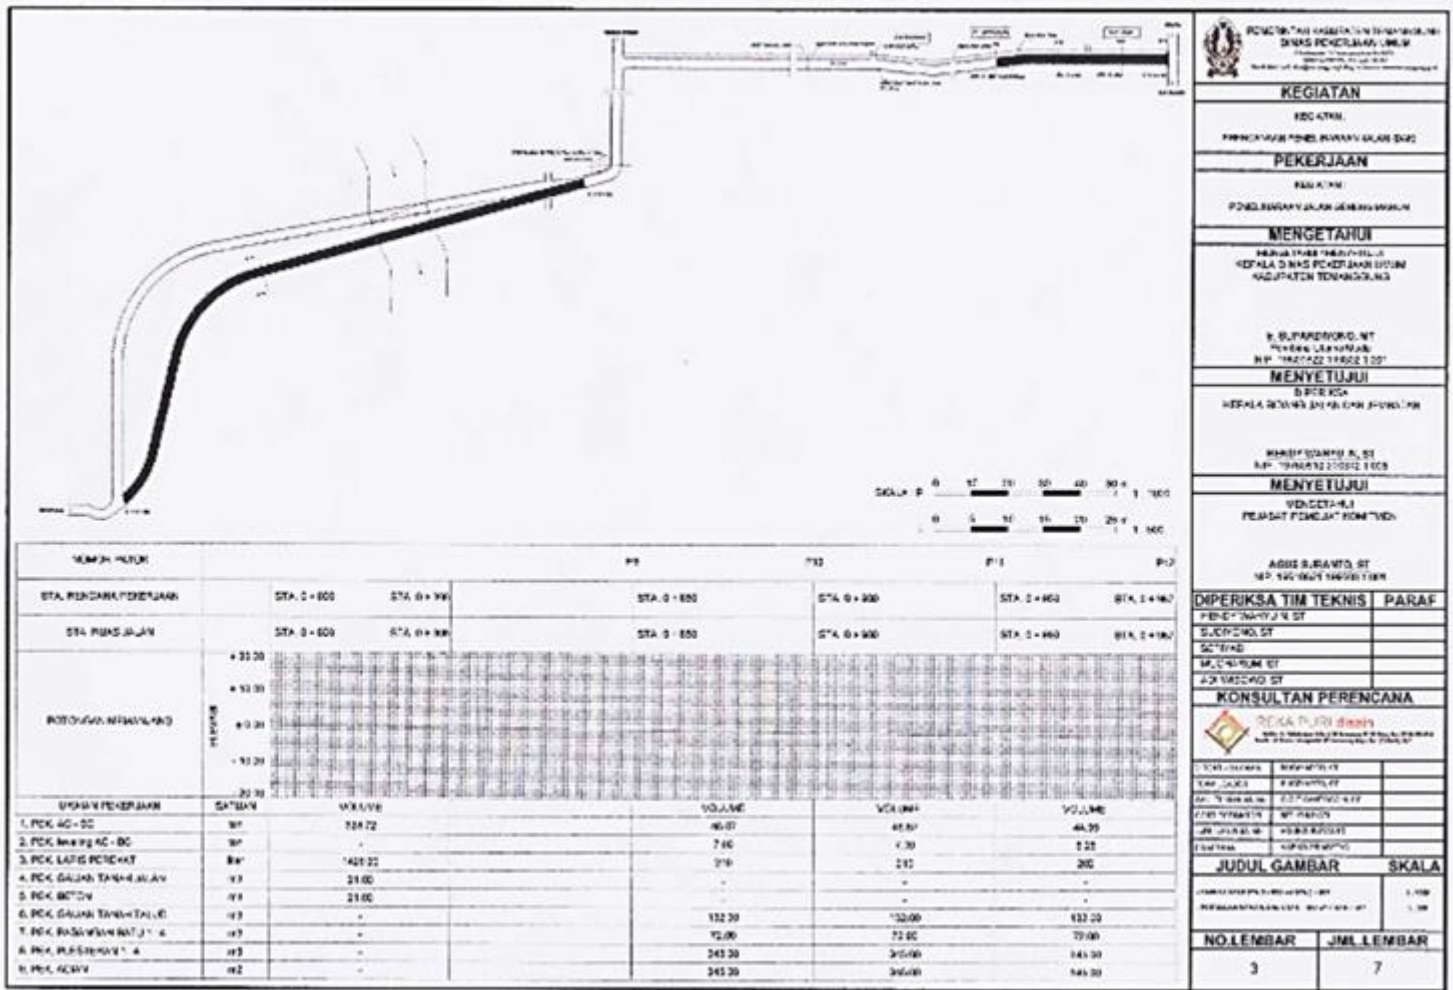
5 Asbuilt Drawing tampak melintang
